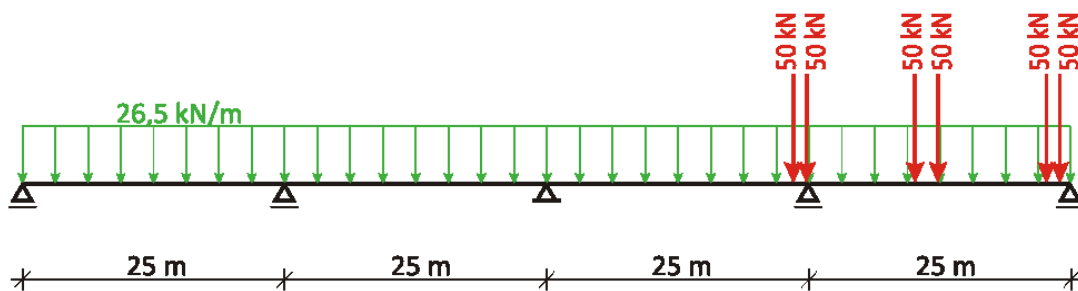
modelo estrutural com o carregamento externo, na situação de serviço
